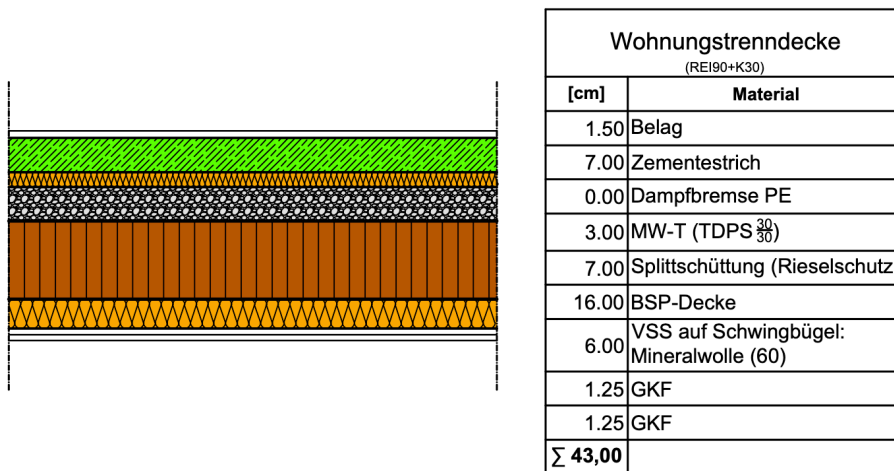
Geschoßdecke Holz-Massivbauweise H-DE 2
